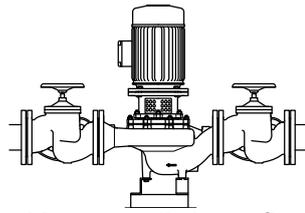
Vertikaler Aufbau / Befestigung mit 3 Winkelfüßen (Stahl 37, Zubehör), Baugrößen 032-032-160 bis 100-100-125
